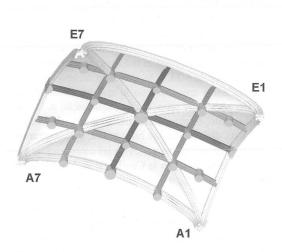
Vista del intradós de la bóveda con sus ligaduras longitudinales y transversales
